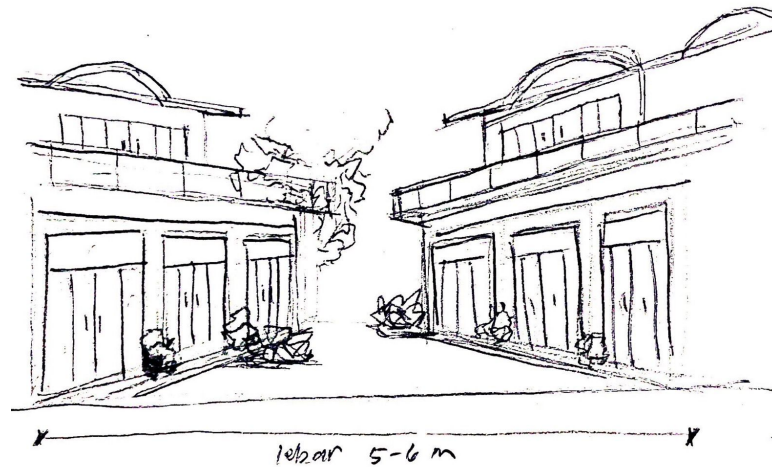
Skematik Area Anchor Tenant Pada Site
